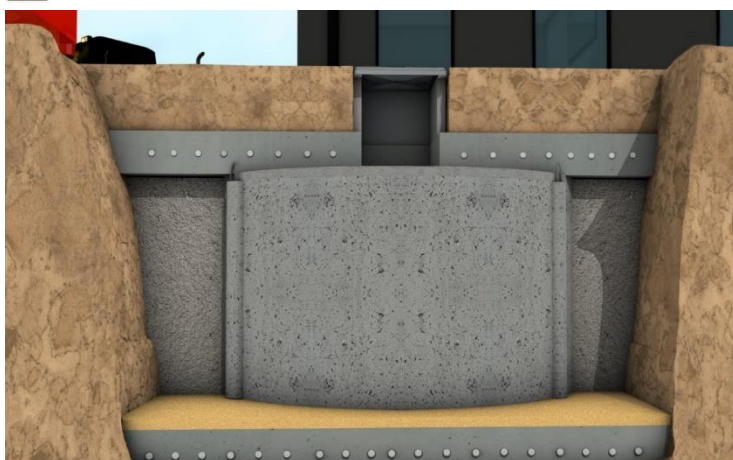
Funderingsplaat in gewapend beton met uitvullingslaag
